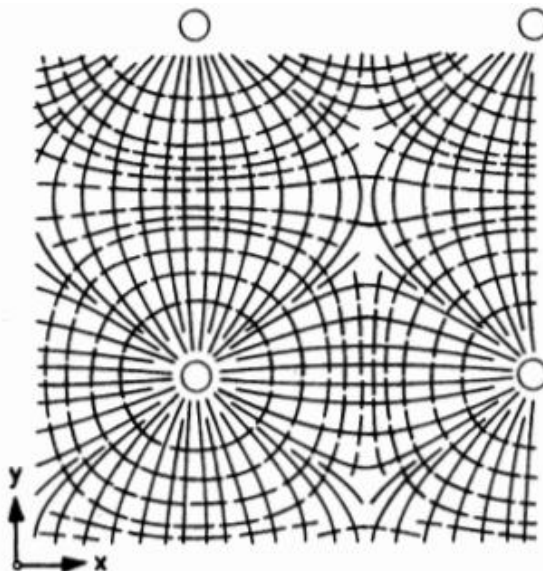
Padrões de fissuração da ligação laje-pilar interno sob carregamento concêntrico
